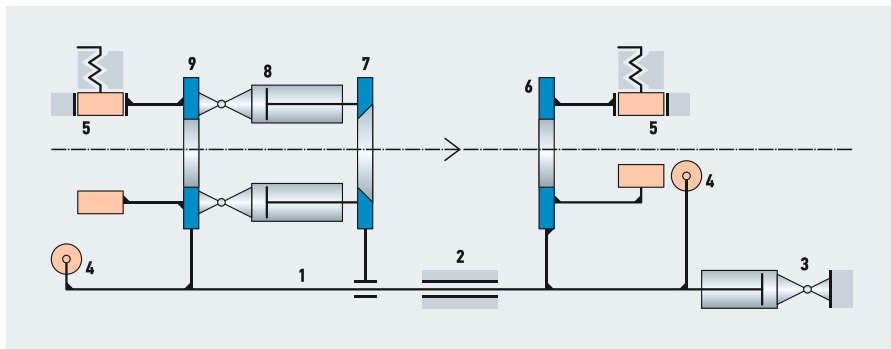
Принципиальная схема гидравлической установки для сборки труб из ВЧШГ с К-ПС [1 — подвижная рама; 2 — направляющие; 3 — гидроцилиндр перемещения рамы; 4 — роликовая опора; 5 — зажим фильерной плиты; 6 — передняя плита; 7 — подвижная плита; 8 — рабочие гидроцилиндры; 9 — задняя плита (стрелка показывает направление сборки трубопровода)]
